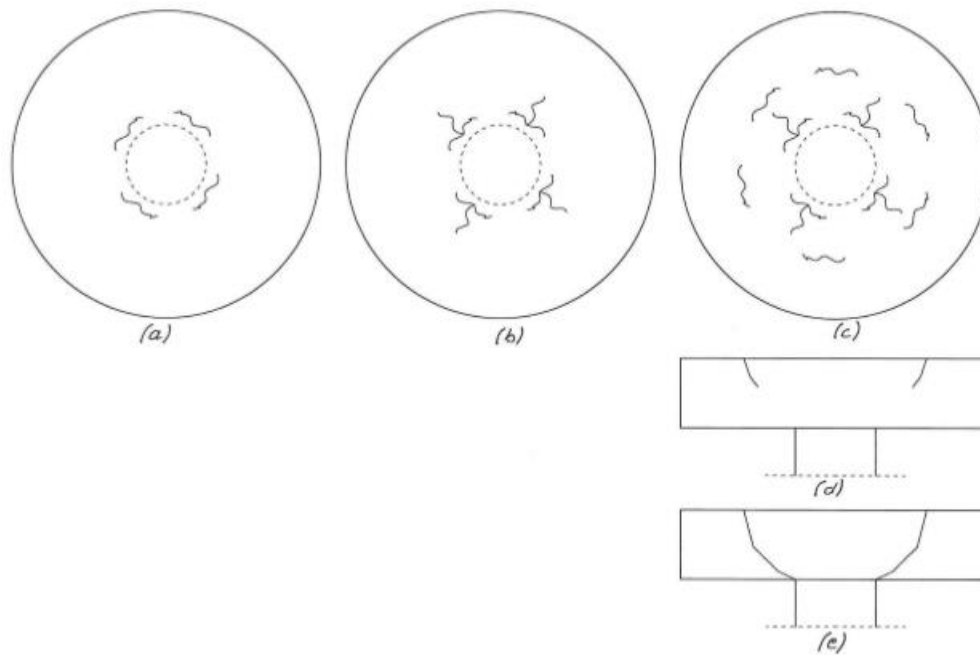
Propagación de fisuras de acuerdo a los ensayos de Kinnunen y Nylander en losas apoyadas (Ericsson & Farahaninia, 2010).
